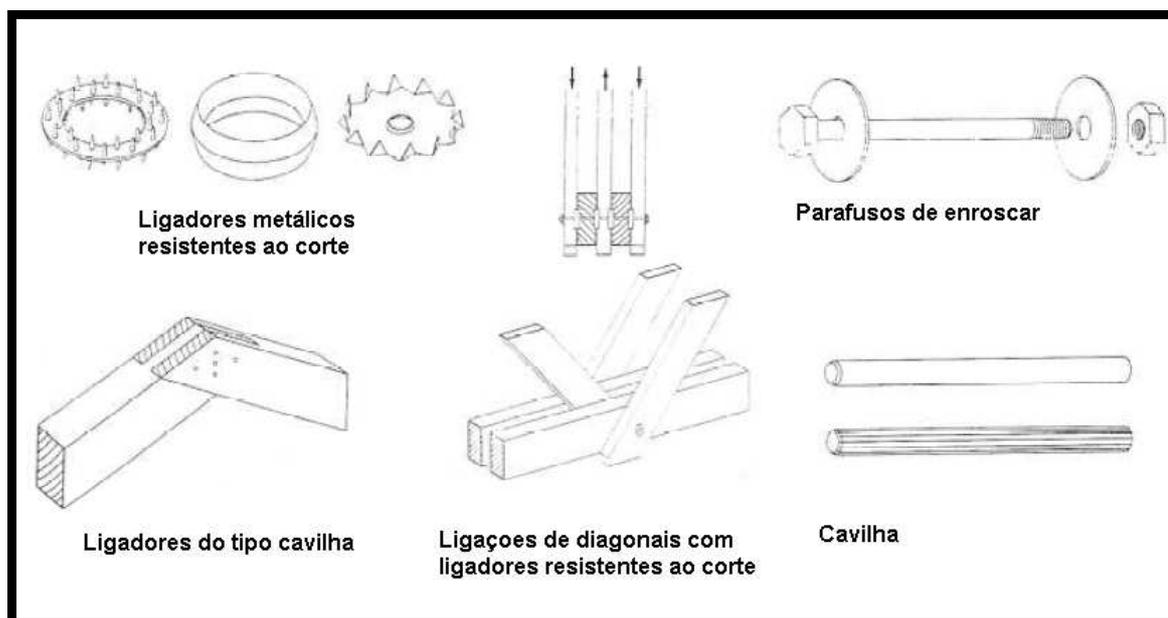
Ligadores comuns em estruturas de madeira [11]
